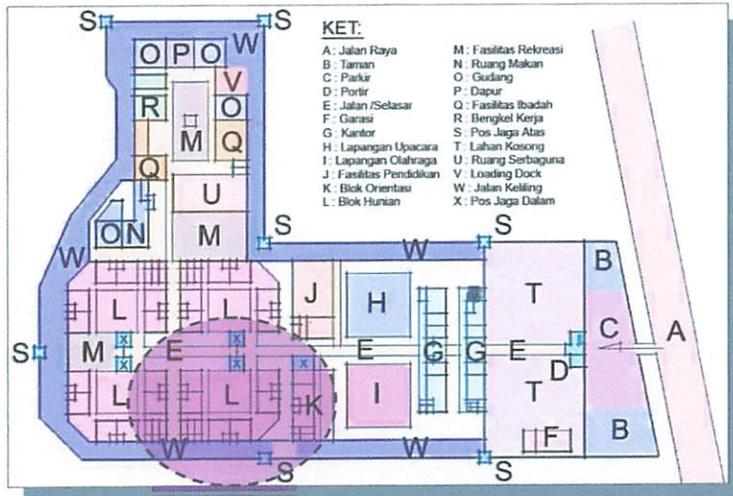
Fasilitas dan jenis ruang lapas IIA wanita malang
